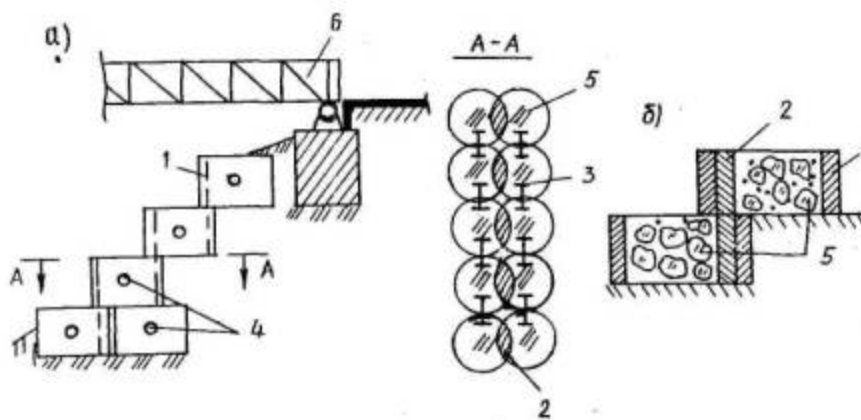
Укрепление насыпи моста железобетонными кольцами:
